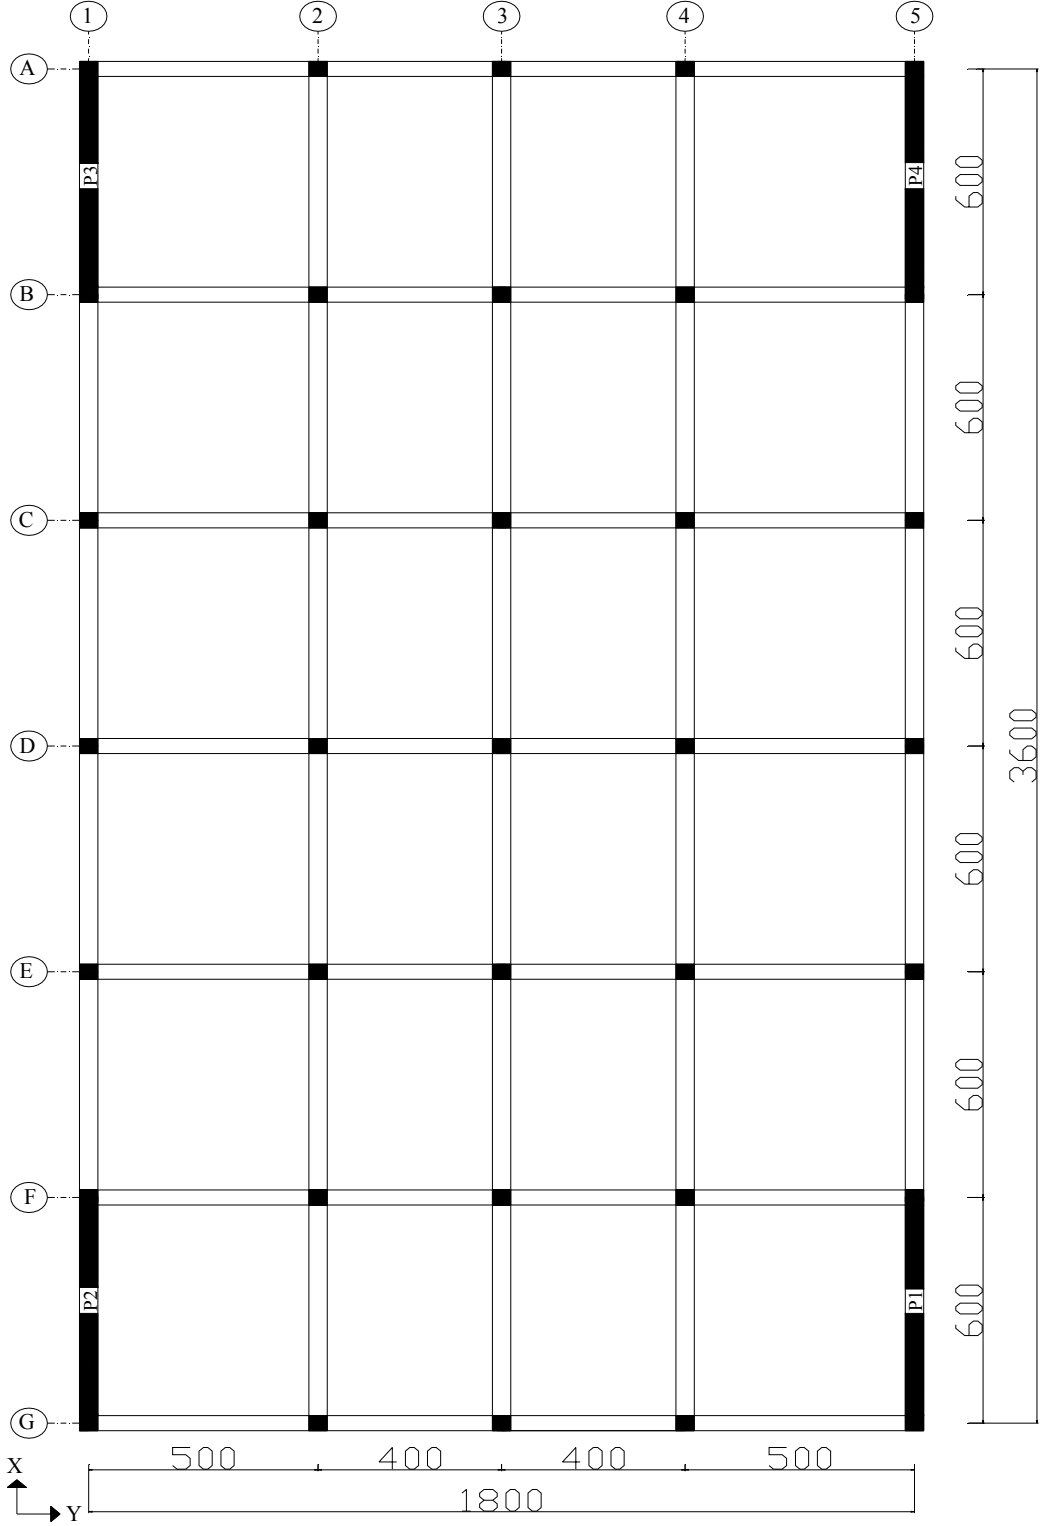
Örnek 5.18'in kat kalıp planı
